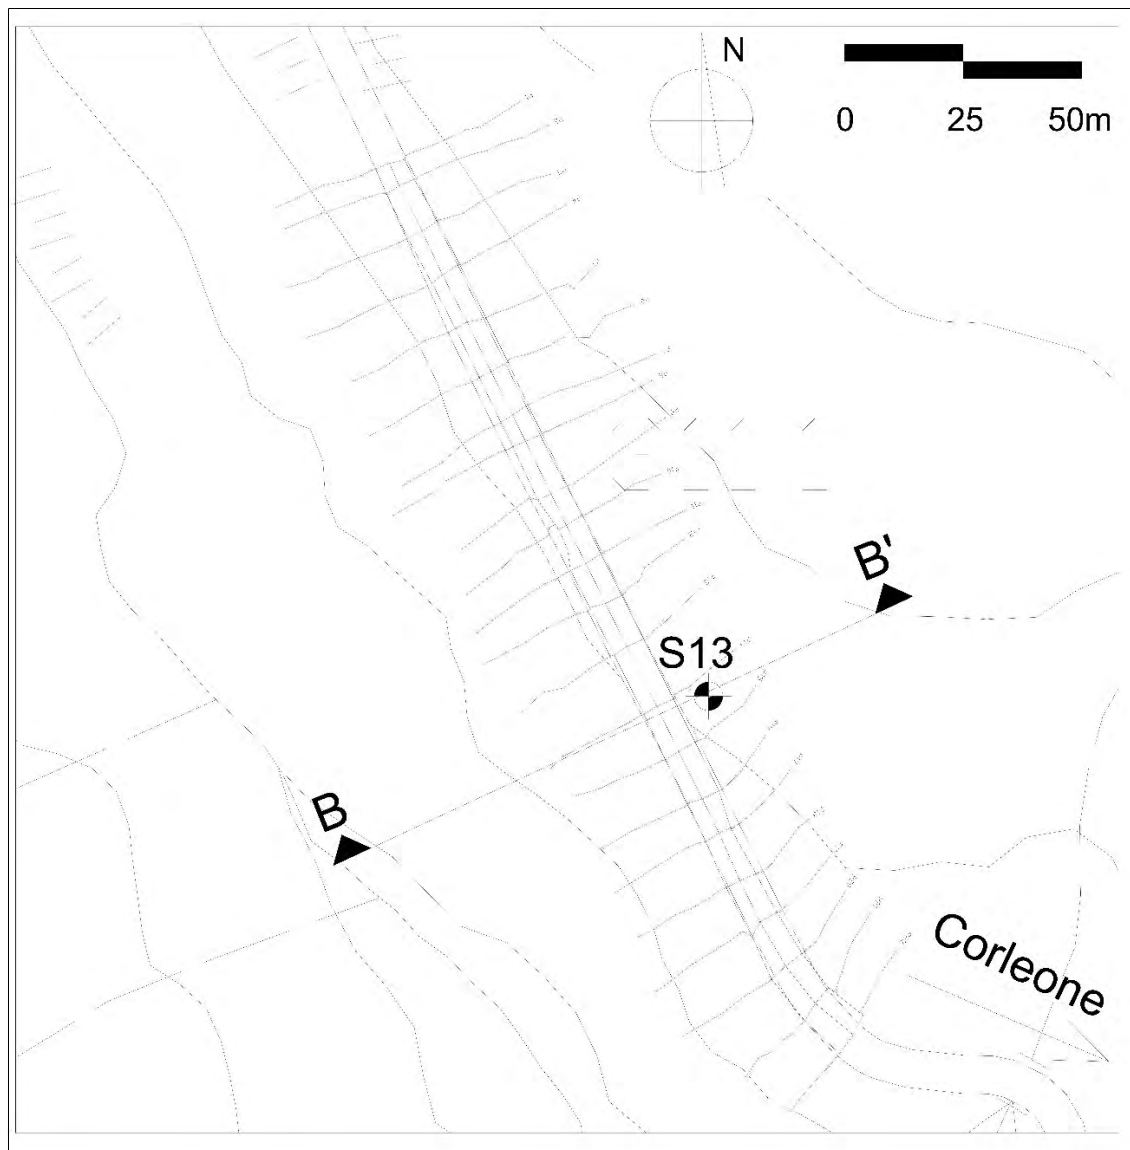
Planimetria con indicazione della zona oggetto di interesse al km 19+000.
